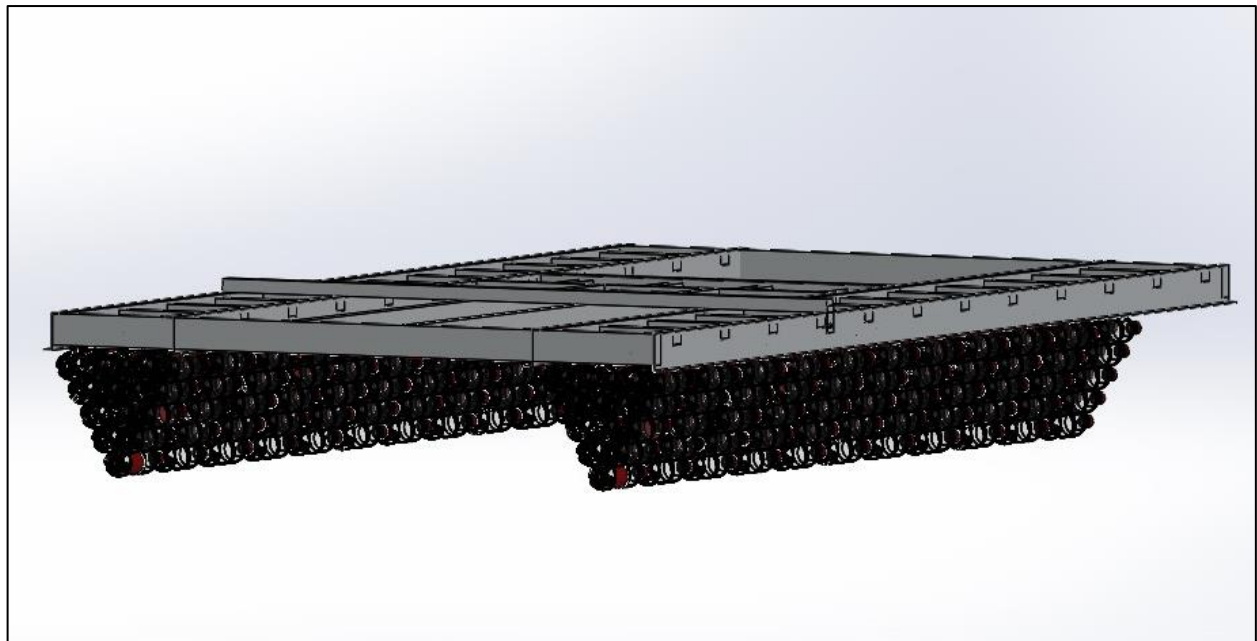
Zúñiga Fernando. (2020) Representación de la estructura de la cubierta
